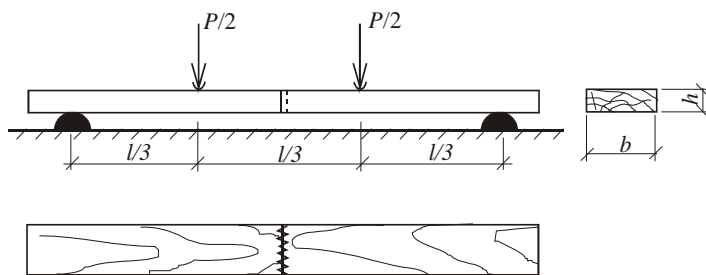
Схема испытания зубчатых клеевых стыков на прочность
